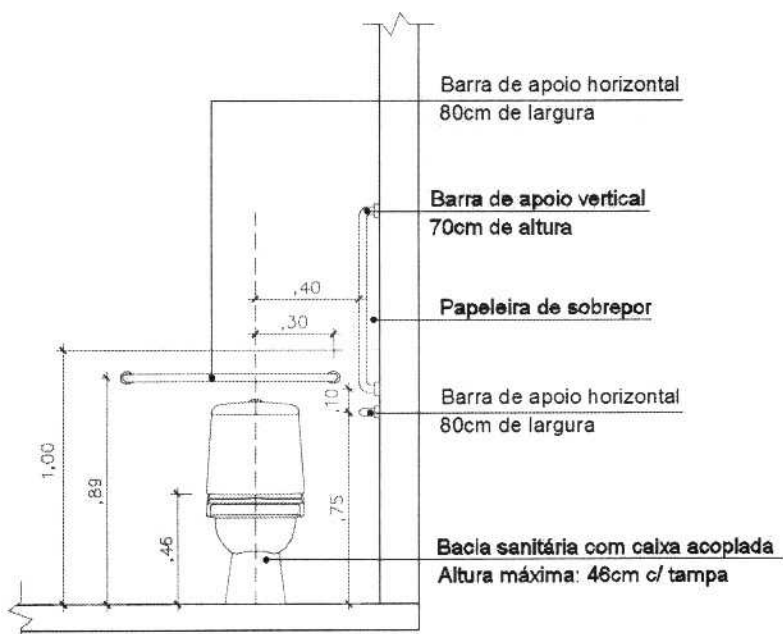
Vista 01 - detalhe de instalação da bacia sanitária
